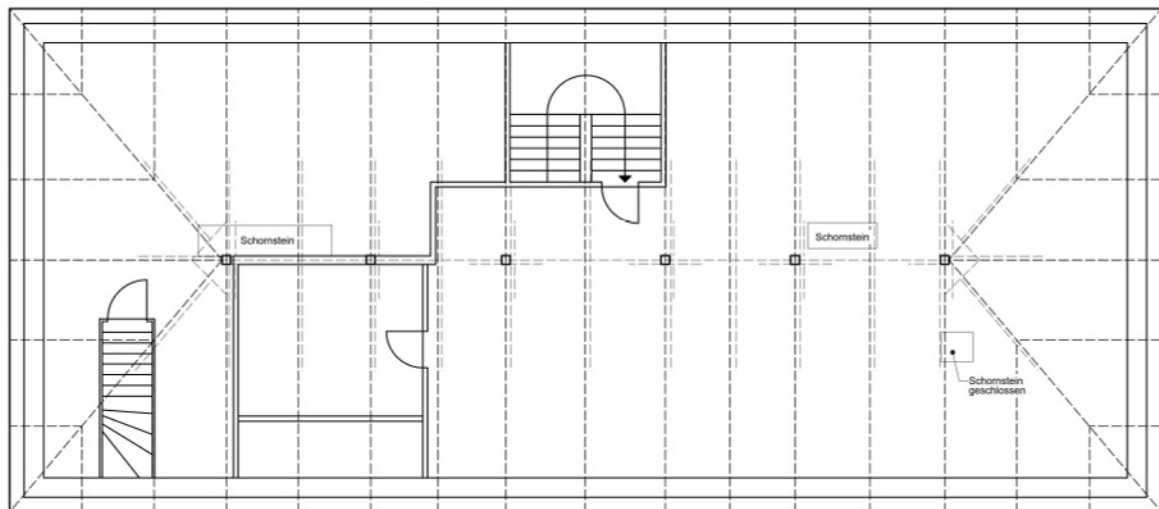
Skizze Grundriss Dachgeschoss
